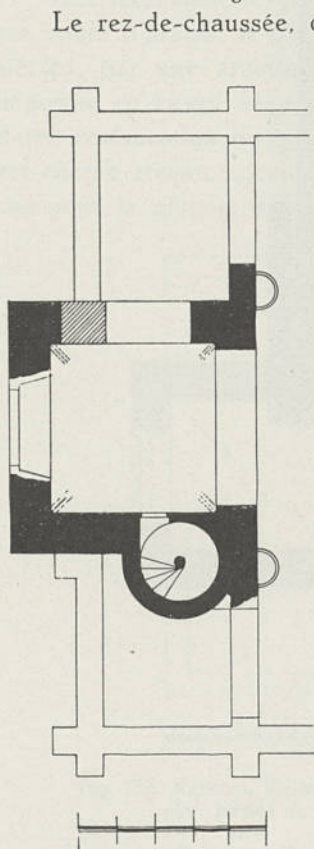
Binkom, Eglise Notre-Dame, plan terrier de la tour
